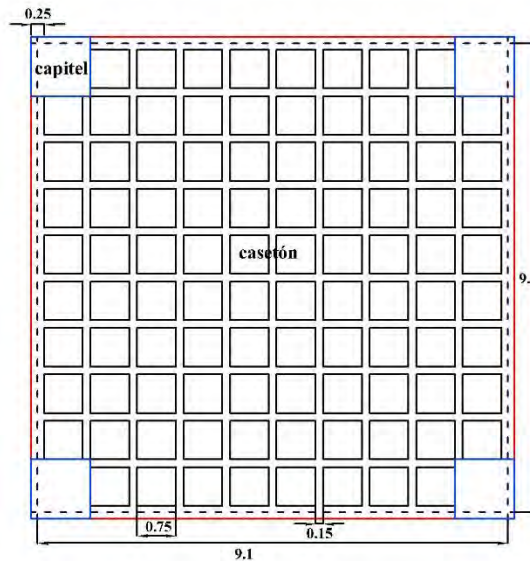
Vista en planta losa encasetonada (cotas en m).
